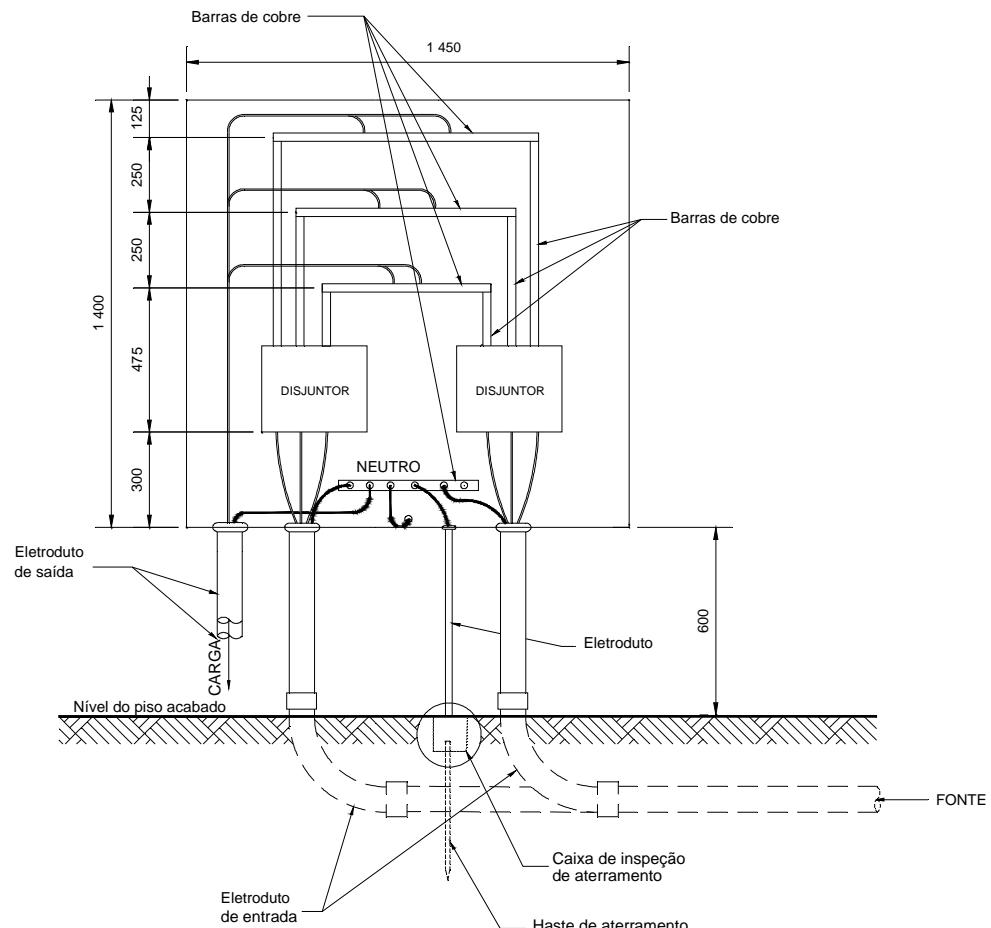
Instalação da proteção da caixa seccionadora tipo T
